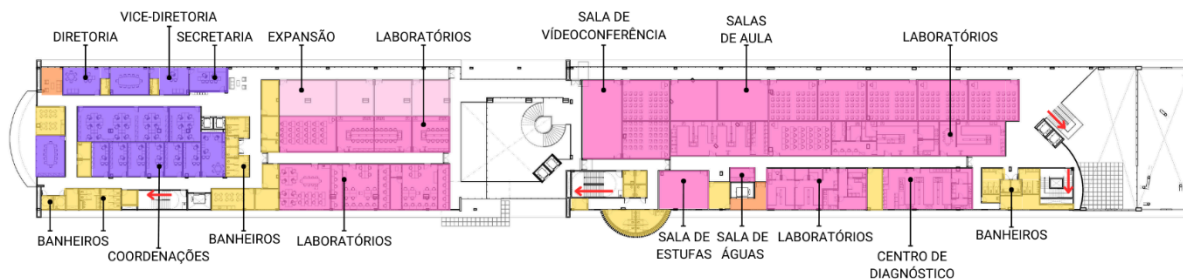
Planta setORIZADA do primeiro pavimento. Fonte: Acervo UFC.
